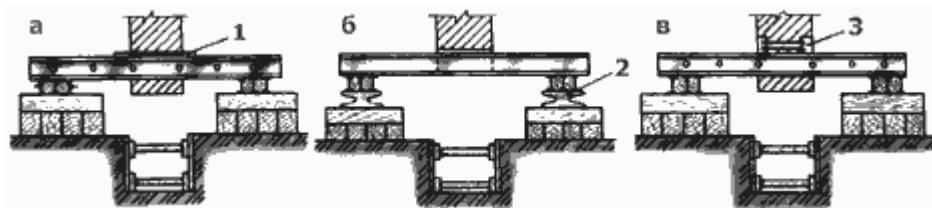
Разгрузка стен вывешиванием при усилении фундаментов: а - при помощи клиньев; б - при помощи домкратов; в - усиление стен балками-обвязками; 1 - клинья; 2 - домкраты; 3 - рандбалка (балка-обвязка).
